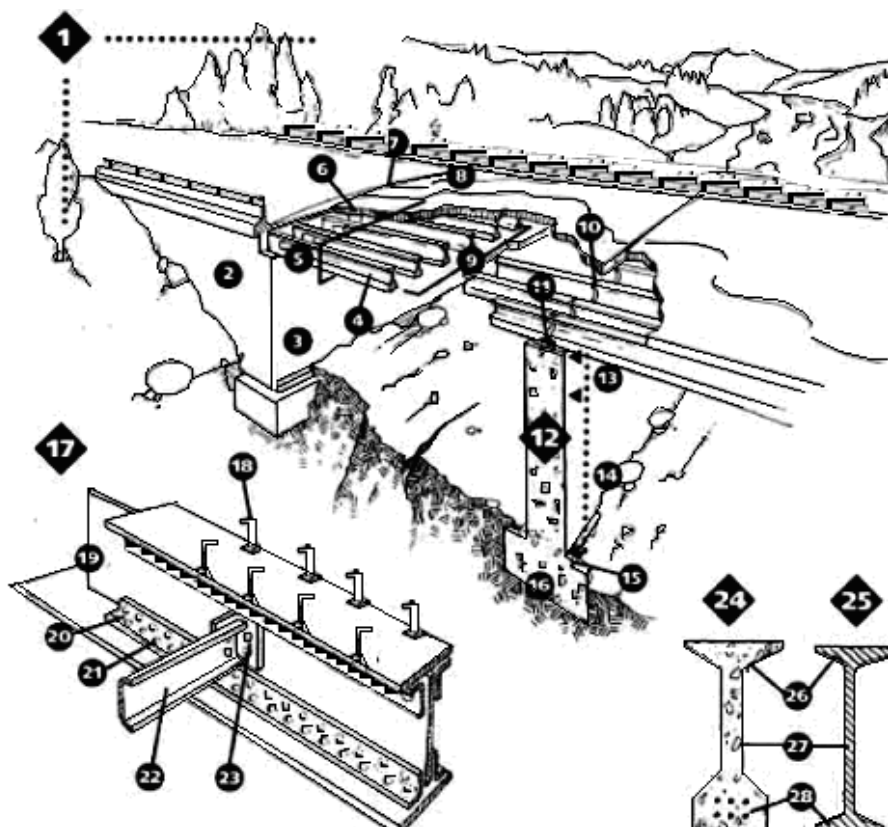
17 Croquis y Elementos de un Puente Tipo de Viga
